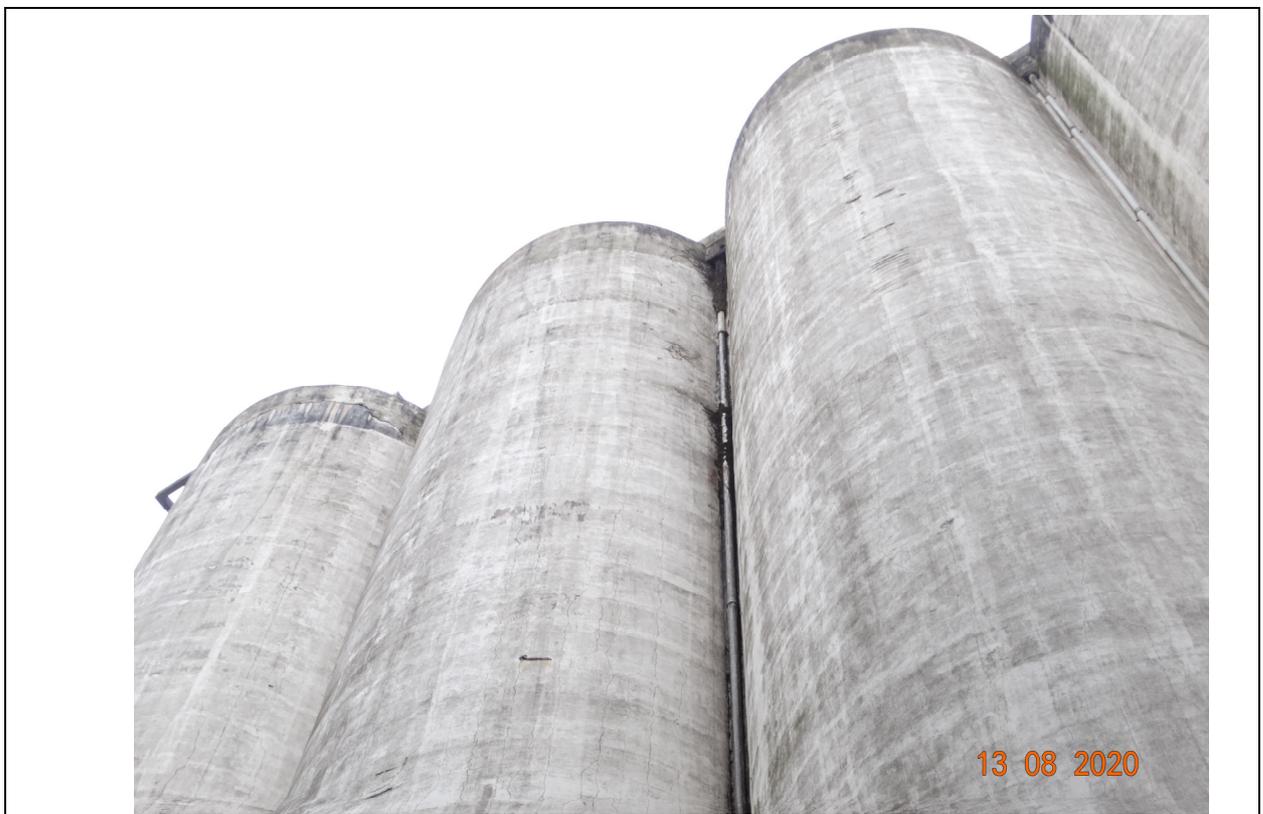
VISTA DO DUTO DE CAPTAÇÃO DE ÁGUA PLUVIAL NA PARTE INFERIOR ENTRE OS SILOS. NOTA-SE O ESCORRIMENTO DE SUJIDADES SOBRE A SUPERFÍCIE DE CONCRETO, FORMANDO FUNGOS E LIMO.
